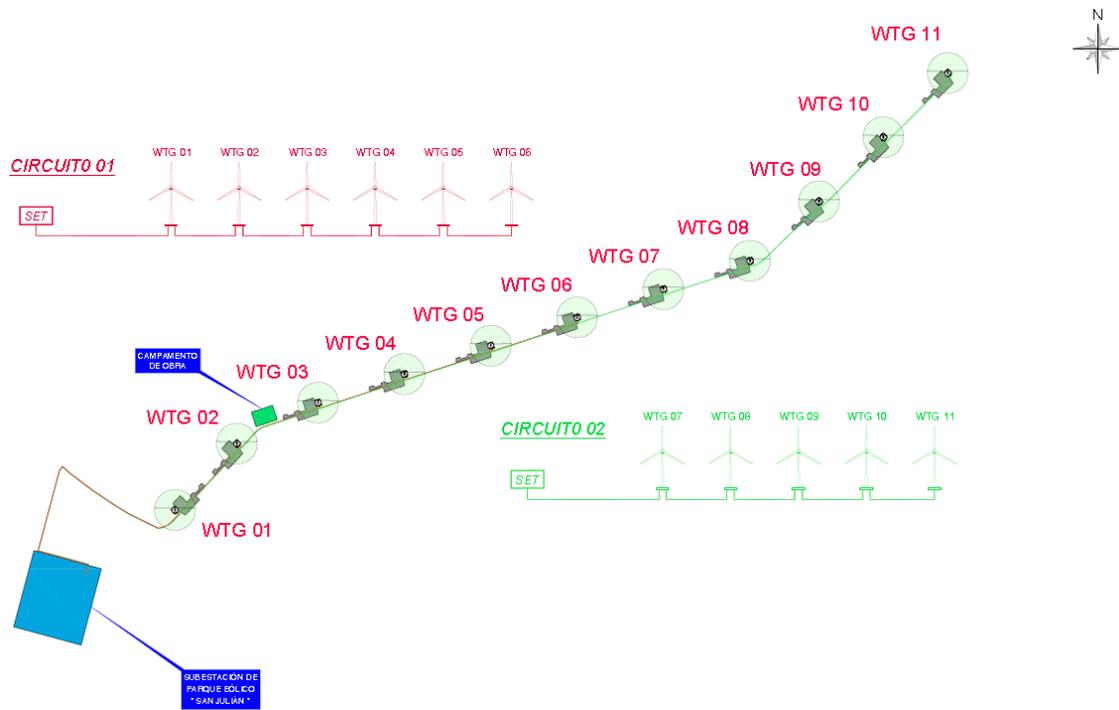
Vista en Planta - Parque Eólico San Julián
